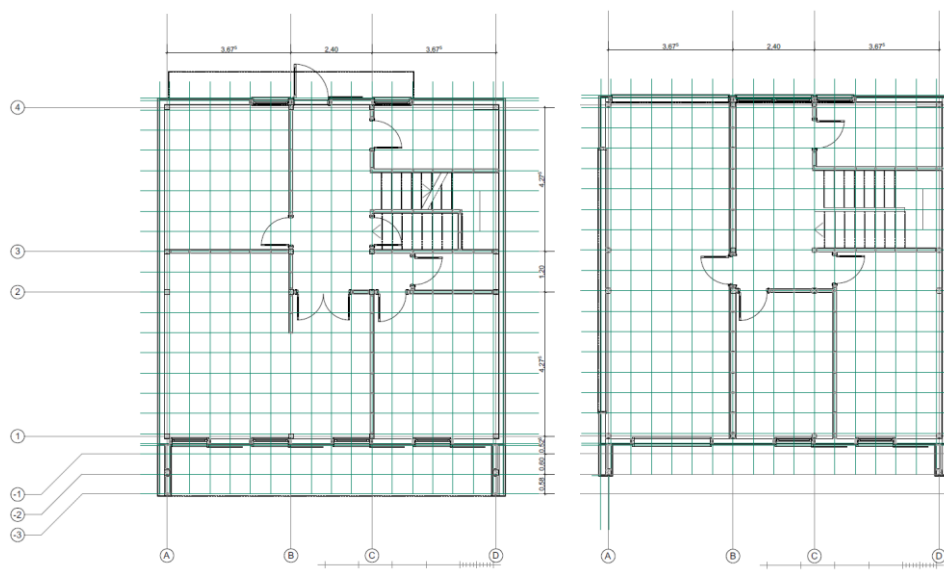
Plantas do Piso 0 e Piso 1 - Integração Arquitectura-Estrutura.
